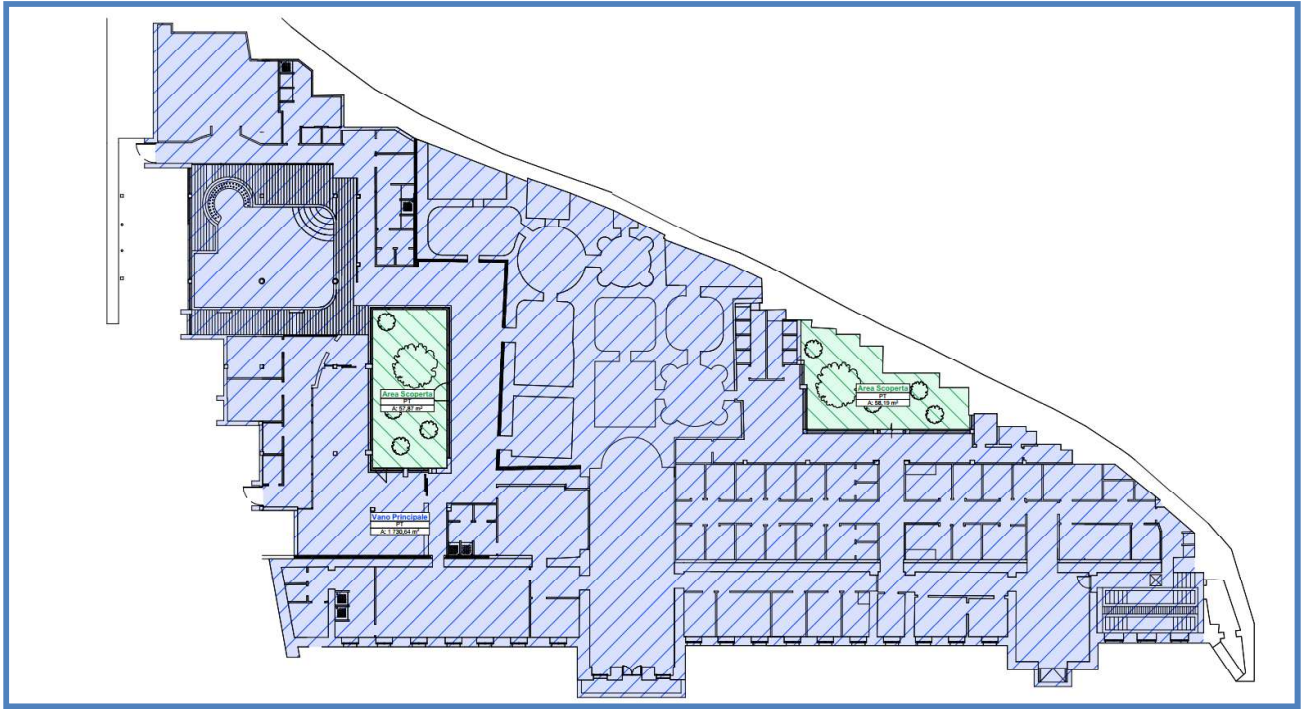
fabbricato stufe – PIANTA PIANO TERRA
